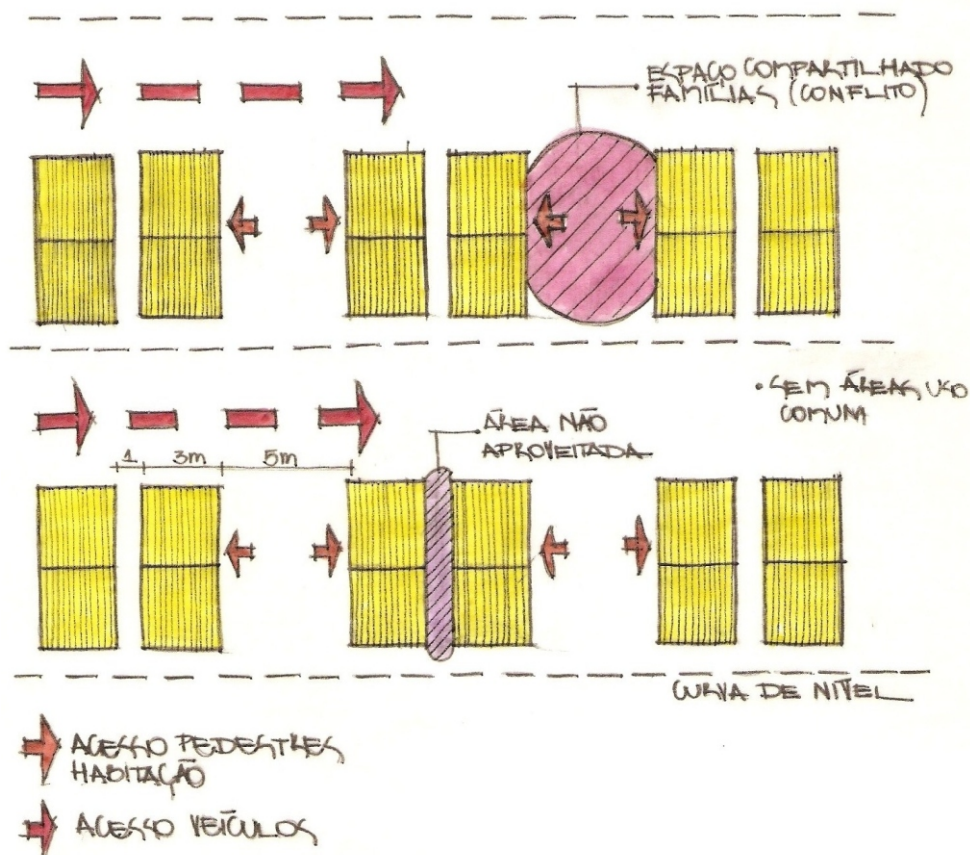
Planta Baixa. Análise Assentamento Provisório no Chile.
